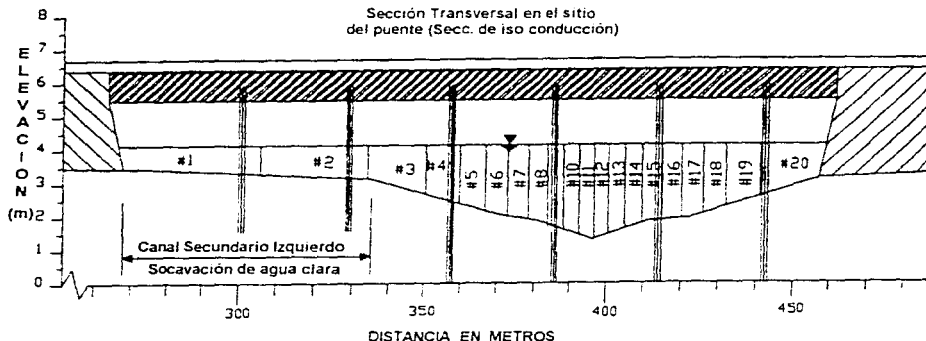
Secciones de iso-conducción en la sección transversal bajo el puente "BP".
